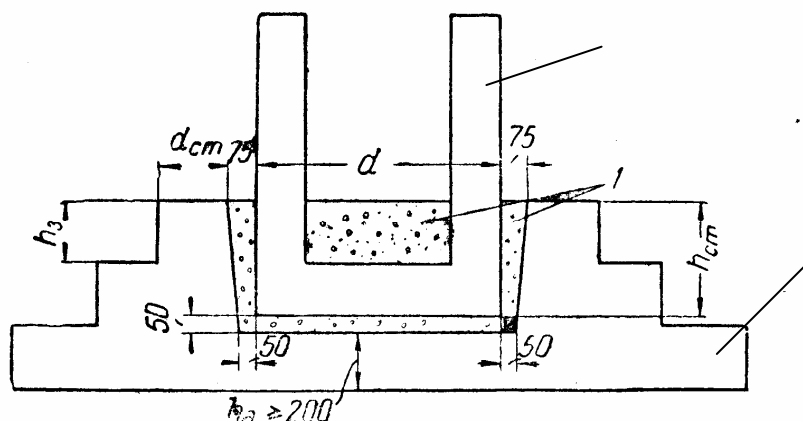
Соотношение размеров колонны и стакана фундамента для колонн сплошного сечения
